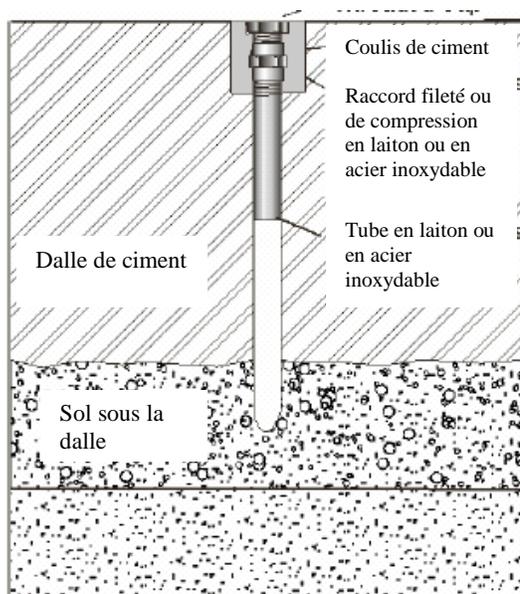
Structure recommandée par l'USEPA (2004) pour les sondes installées sous la dalle d'un bâtiment
